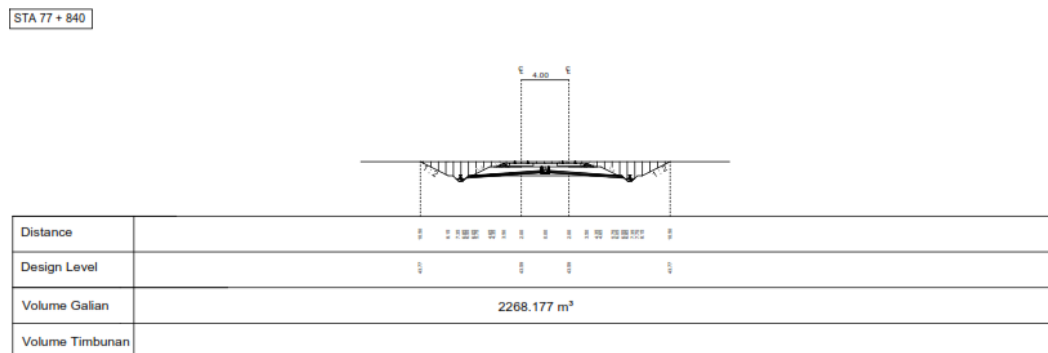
Potongan Pada Daerah Galian Tinggi Tanpa *Retaining Wall
